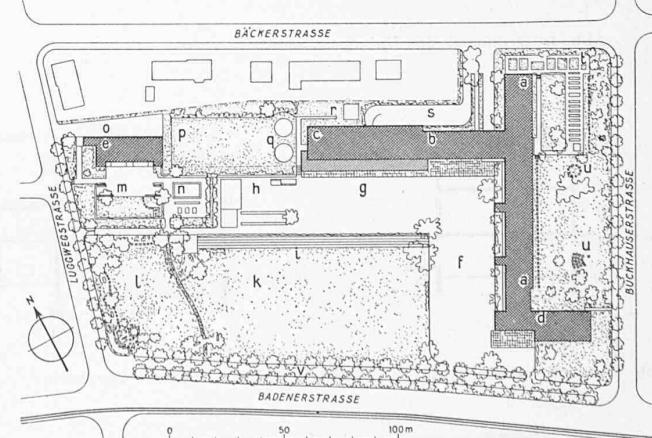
Lageplan der Schulhausanlage Zürich-Altstetten, 1:3000
